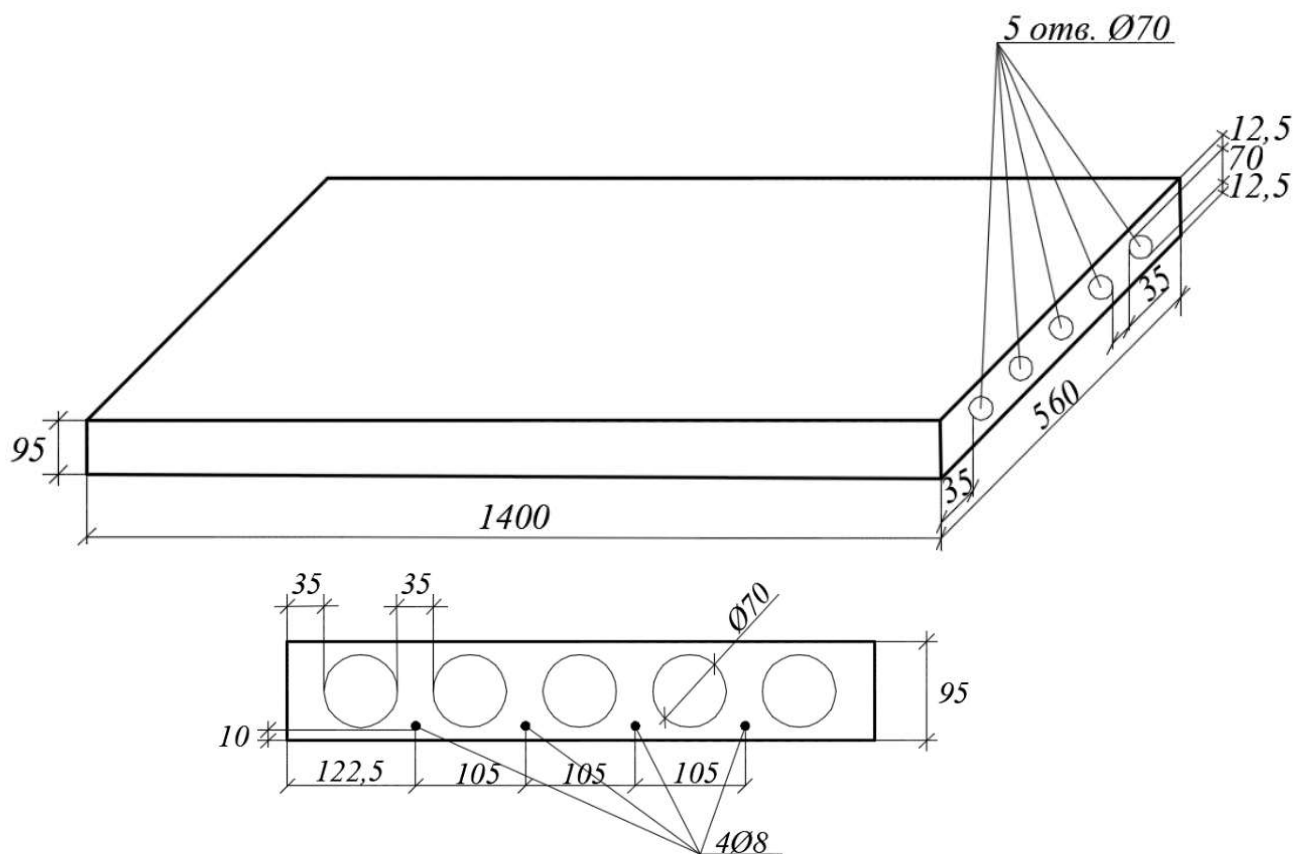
Модель залізобетонної багатопустотної плити перекриття
